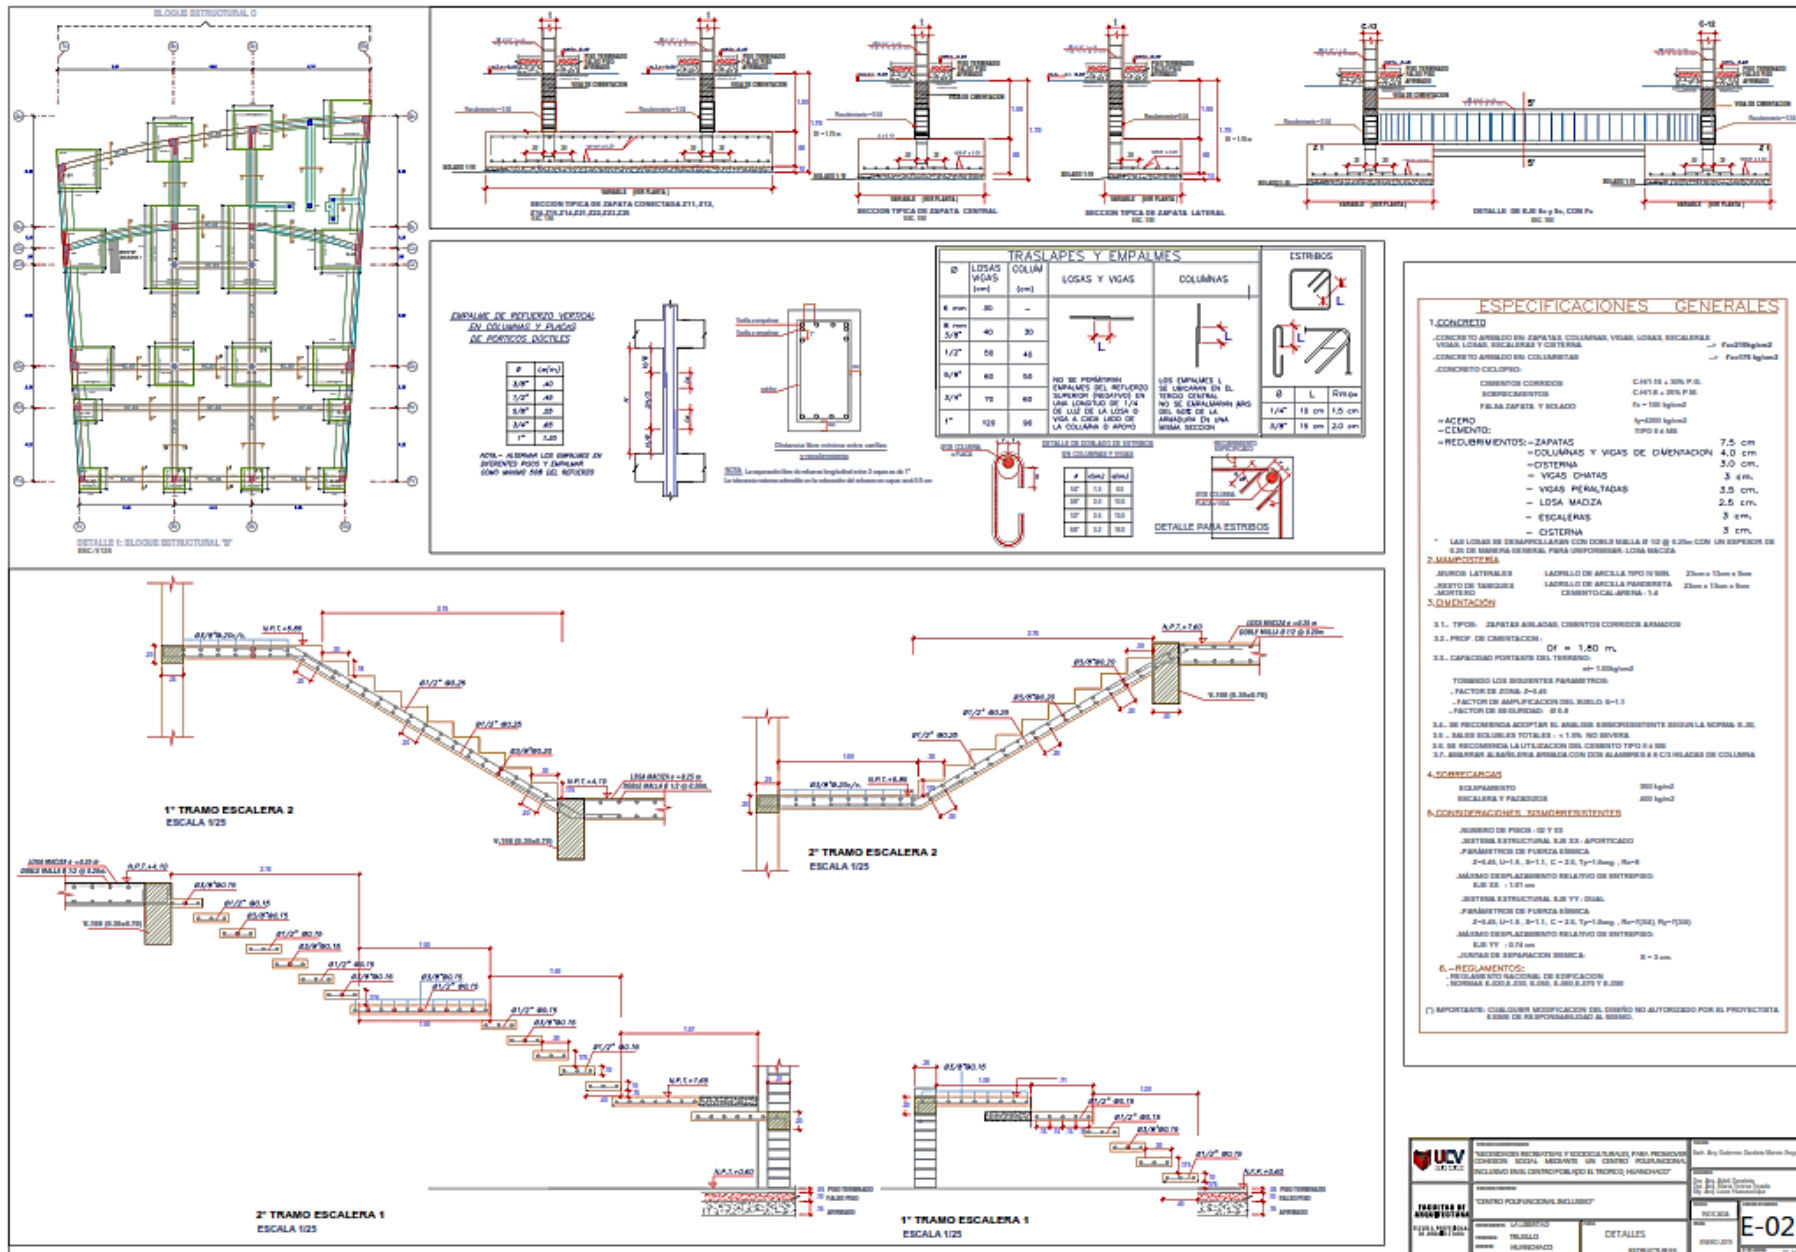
Plano Estructural de cimentaciones y escalera: E-02. Fuente: Propia (2018)
